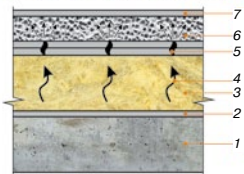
Разрез плоской кровли после обычной реконструкции (наклейка нового гидроизоляционного ковра): 1 – основание кровли, как правило, железобетонная плита; 2 – слой пароизоляции; 3 – слой старой, увлажненной из-за протечек теплоизоляции (минеральная вата, пенополистирол, керамзит, легкий бетон и т. п.); 4 – путь миграции паровоздушной смеси в теплоизоляционном слое при нагреве кровли; 5 – повреждения старого гидроизоляционного ковра; 6 – избыточное давление, создаваемое мигрирующими водяными парами; 7 – вздутия на поверхности новой кровельной мембраны, уложенной при реконструкции кровли
